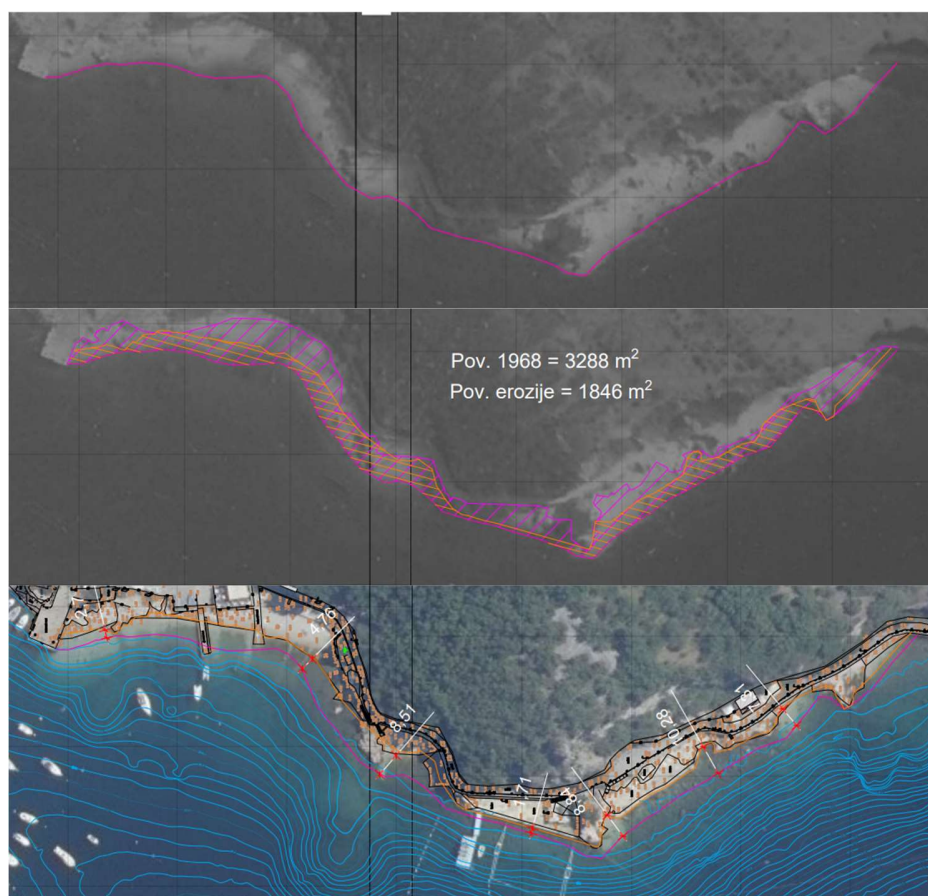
Uređenje betonske plaže – pozicija C (Izvor: Izrada autora)
